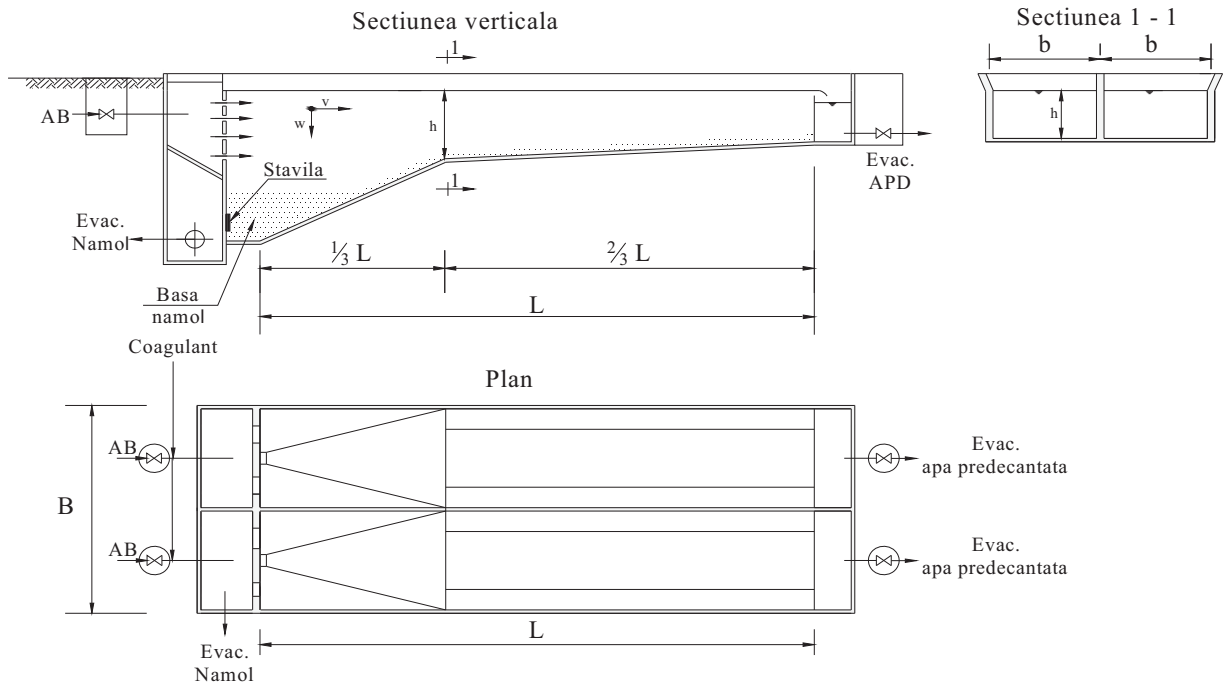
Schemă predecantor orizontal-longitudinal: plan și secțiuni.
